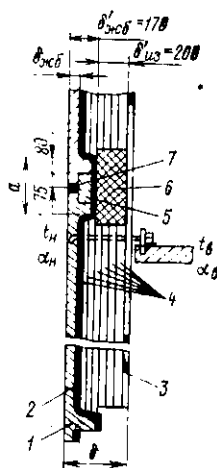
Конструкция сборных стеновых вертикальных изолированных панелей многэтажных холодильников и крепление к междуэтажному железобетонному перекрытию:
